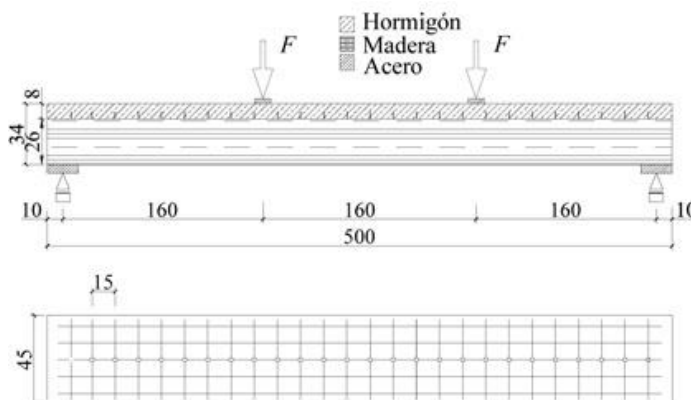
Viga mixta con los materiales debidamente conectados, en la que el hormigón de la parte superior asume los esfuerzos de compresión y el acero desempeña la misma labor con los de tracción.
